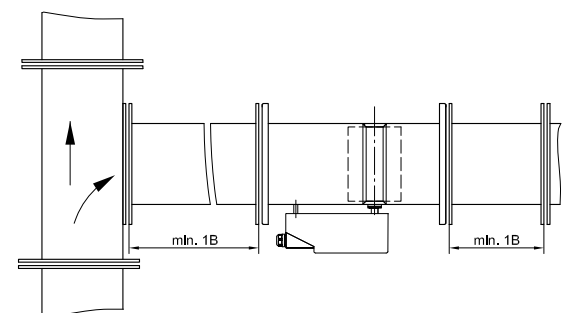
Einbau nach Störstelle, z.B. T-Stücke
